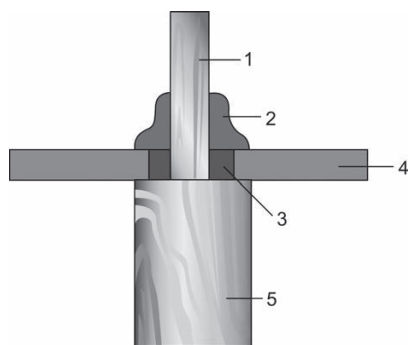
Установка перегородки на балку: 1 — перегородка; 2 — плинтус; 3 — брусок; 4 — пол; 5 — балка
